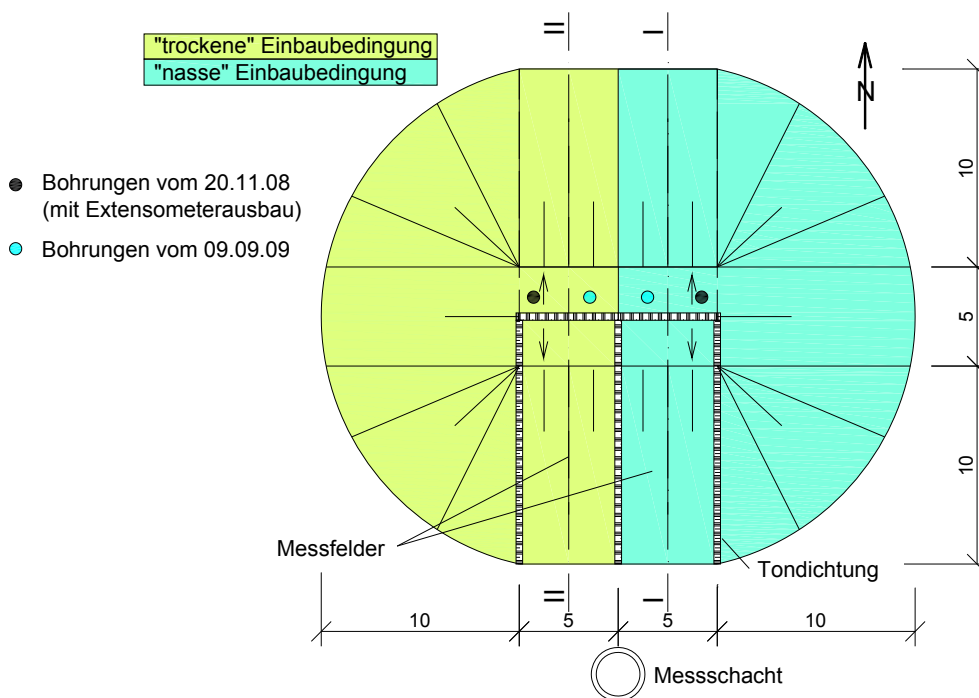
Grundriss der Versuchsschüttung (Prinzipdarstellung), Abmessungen in m
